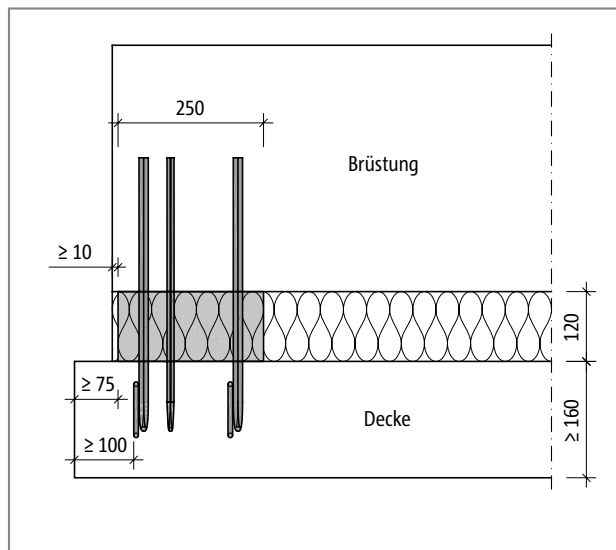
Schöck Isokorb® XT Typ A: Ansicht Randabstände
